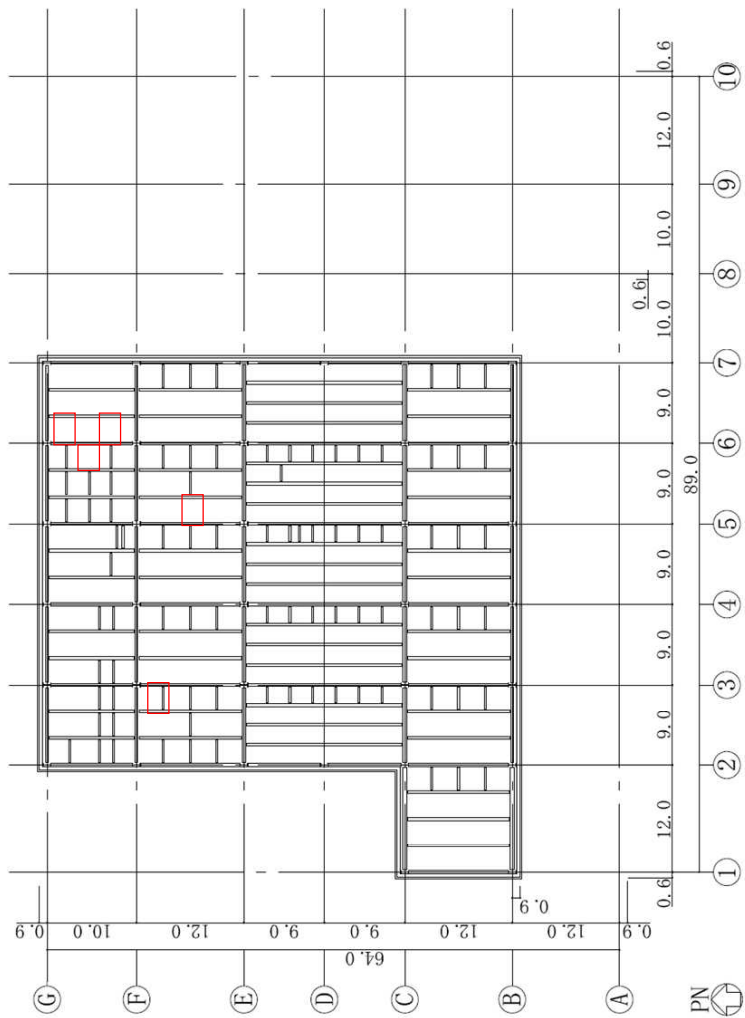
屋上階平面図 (G.L. +12.3) (単位 : m)
